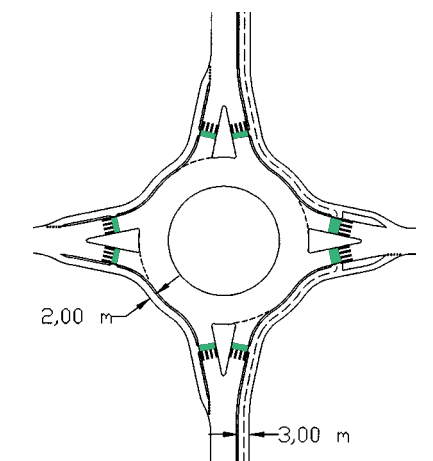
Piste cyclable bidirectionnelle sur giratoire
